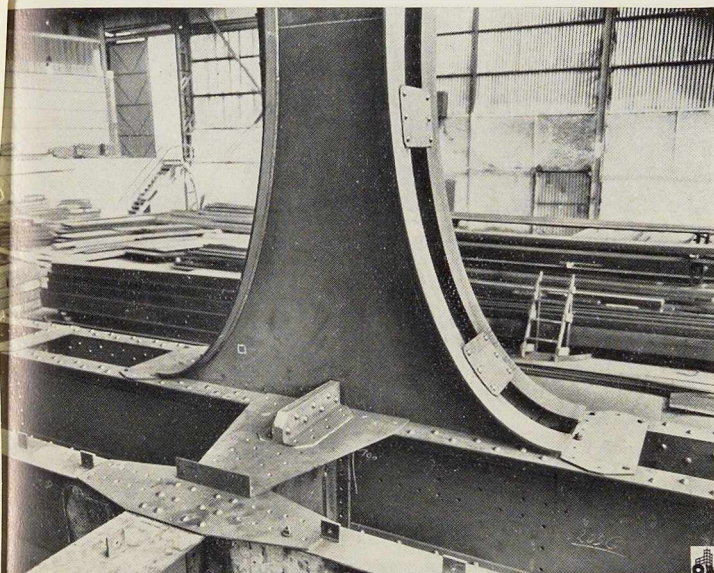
Assemblage d'une traverse de contreventement supérieur à la maîtresse-poutre.
